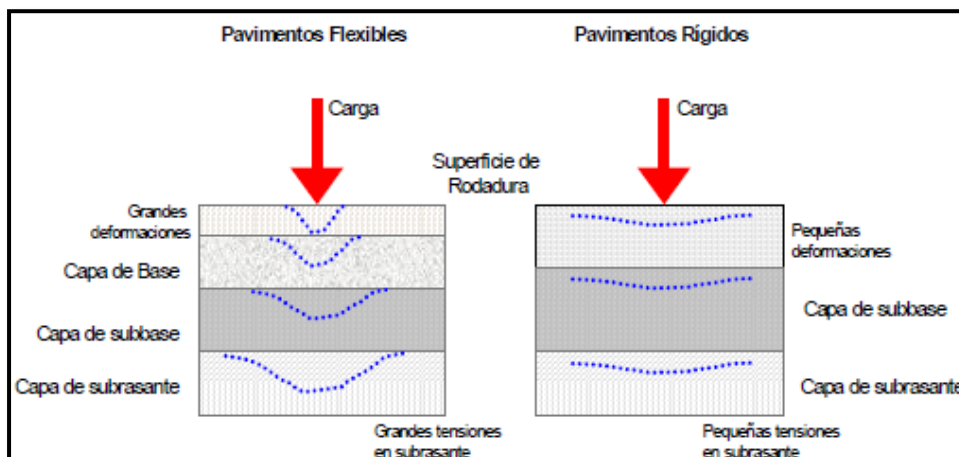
Comportamiento de Pavimentos Rígidos y Flexibles
